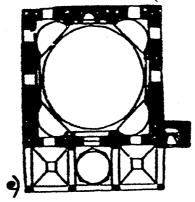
مسقط أفقي لمسجد علي باشا في Szigetvar المجرية (عن : جيرو) .
